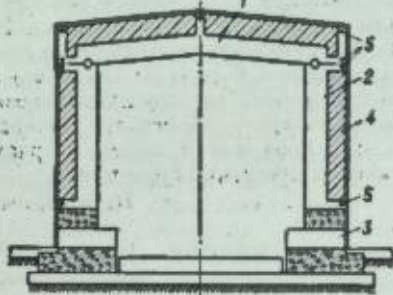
Поперечный разрез туннельной печи из жаростойкого железобетона: 1 — сводчатая панель; 2 — стенная панель; 3 — фундаментный блок; 4 — термоизоляция; 5 — арматура.
